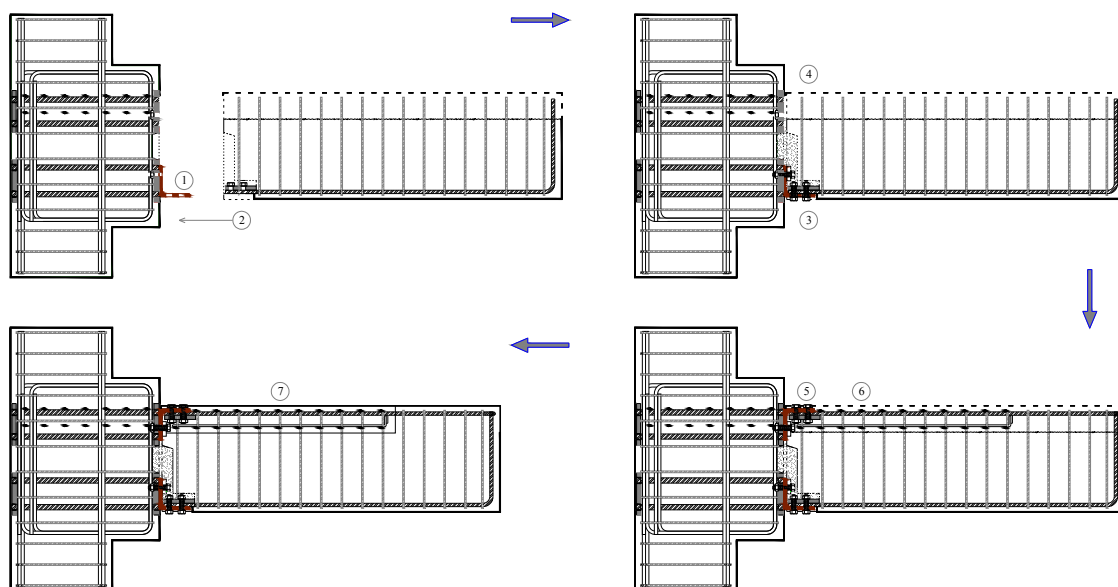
Faseamento construtivo do modelo pré-fabricado: 1. Aparafusamento da cantoneira inferior ao pilar; 2. Montagem da viga sobre a cantoneira inferior; 3. Aparafusamento das armaduras inferiores; 4. Selagem da junta com calda armada com fibras de aço; 5. Aparafusamento da cantoneira superior ao pilar; 6. Posicionamento da armadura superior e aparafusamento à cantoneira superior; 7. Betonagem da laje e da face superior da viga.
